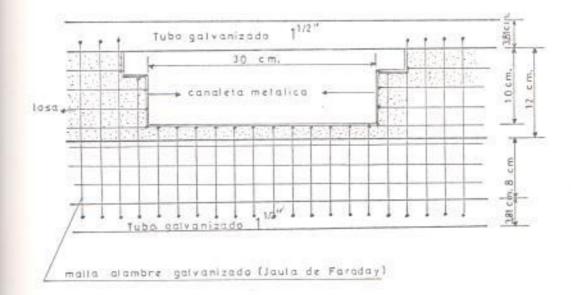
Detalle conexión canaleta a Jaula de Faraday.
